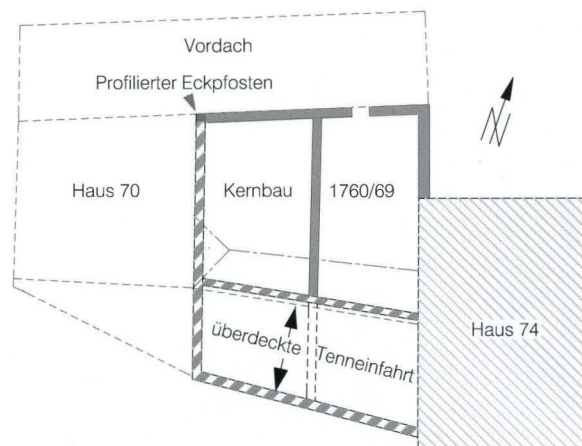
Obere Dorfstrasse 70. Grundriss mit Rekonstruktion. – Zeichnung: Hans Ritzmann.
